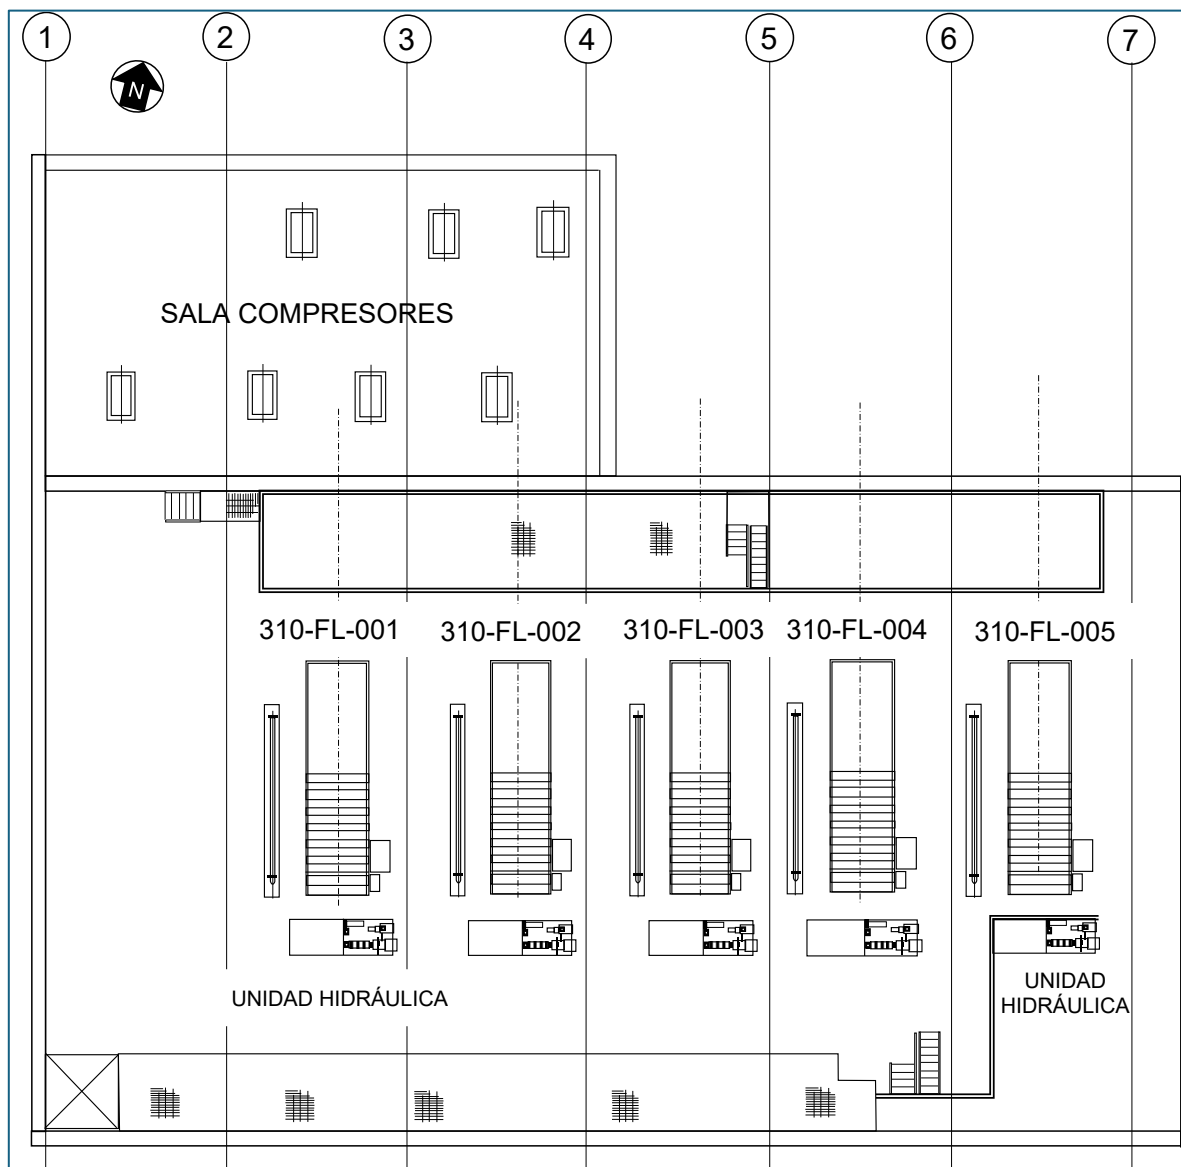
Esquema Simplificado de La Planta de Filtros en Punta Patache
